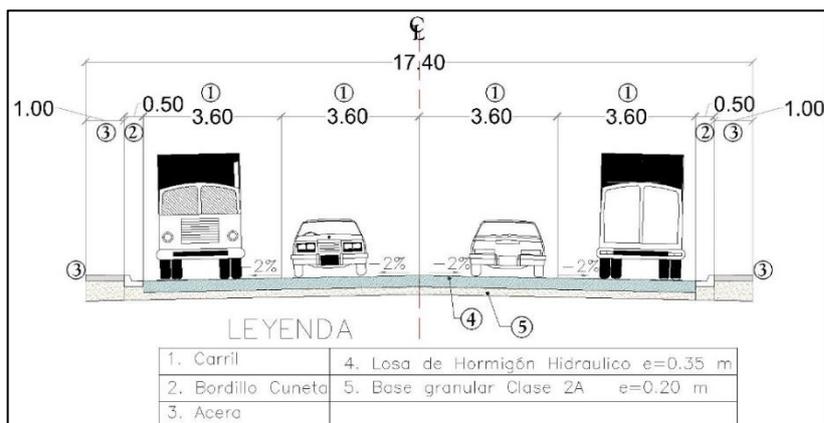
Sección Transversal para el tramo 2 de la alternativa 2.
